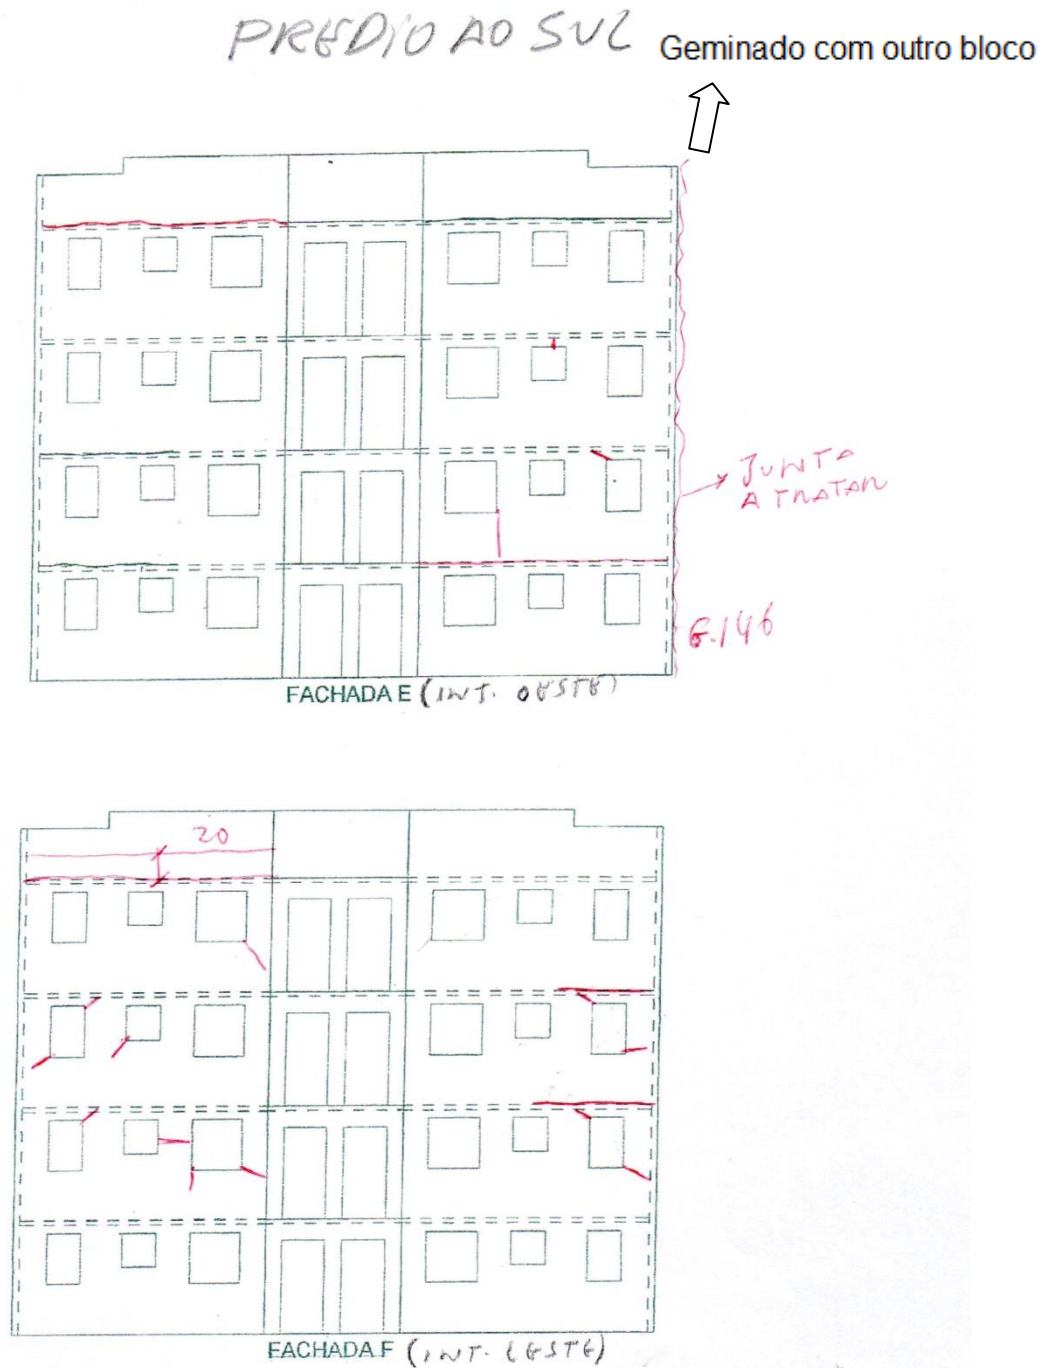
Mapa de Fissuras (próprios autores).
